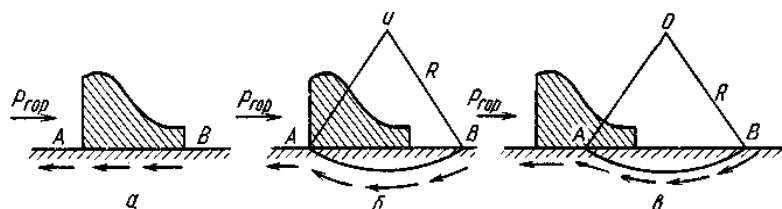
Поверхности скольжения при определении устойчивости плотин на сдвиг: а – плоский сдвиг; б – сдвиг с частью грунта основания по всей подошве плотины; в – сдвиг с частью грунта основания при расположении кривой скольжения под частью подошвы плотины
